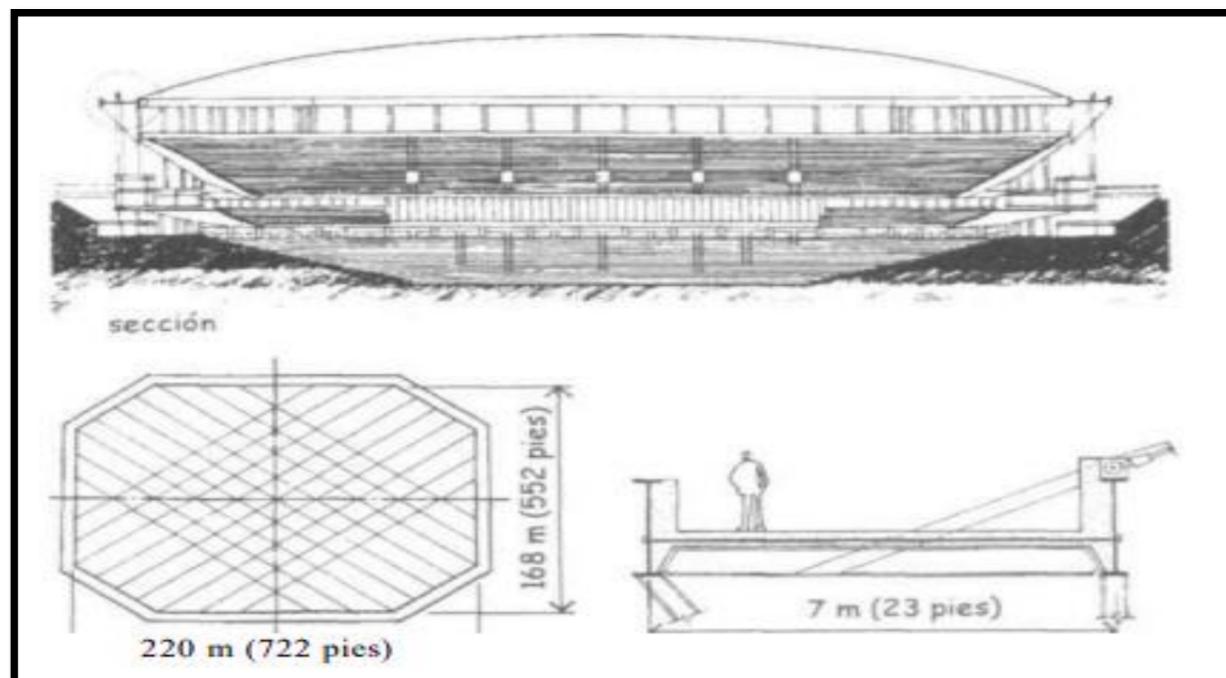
Silverdome, Sección, planta del techo, sección a través del anillo perimetral
